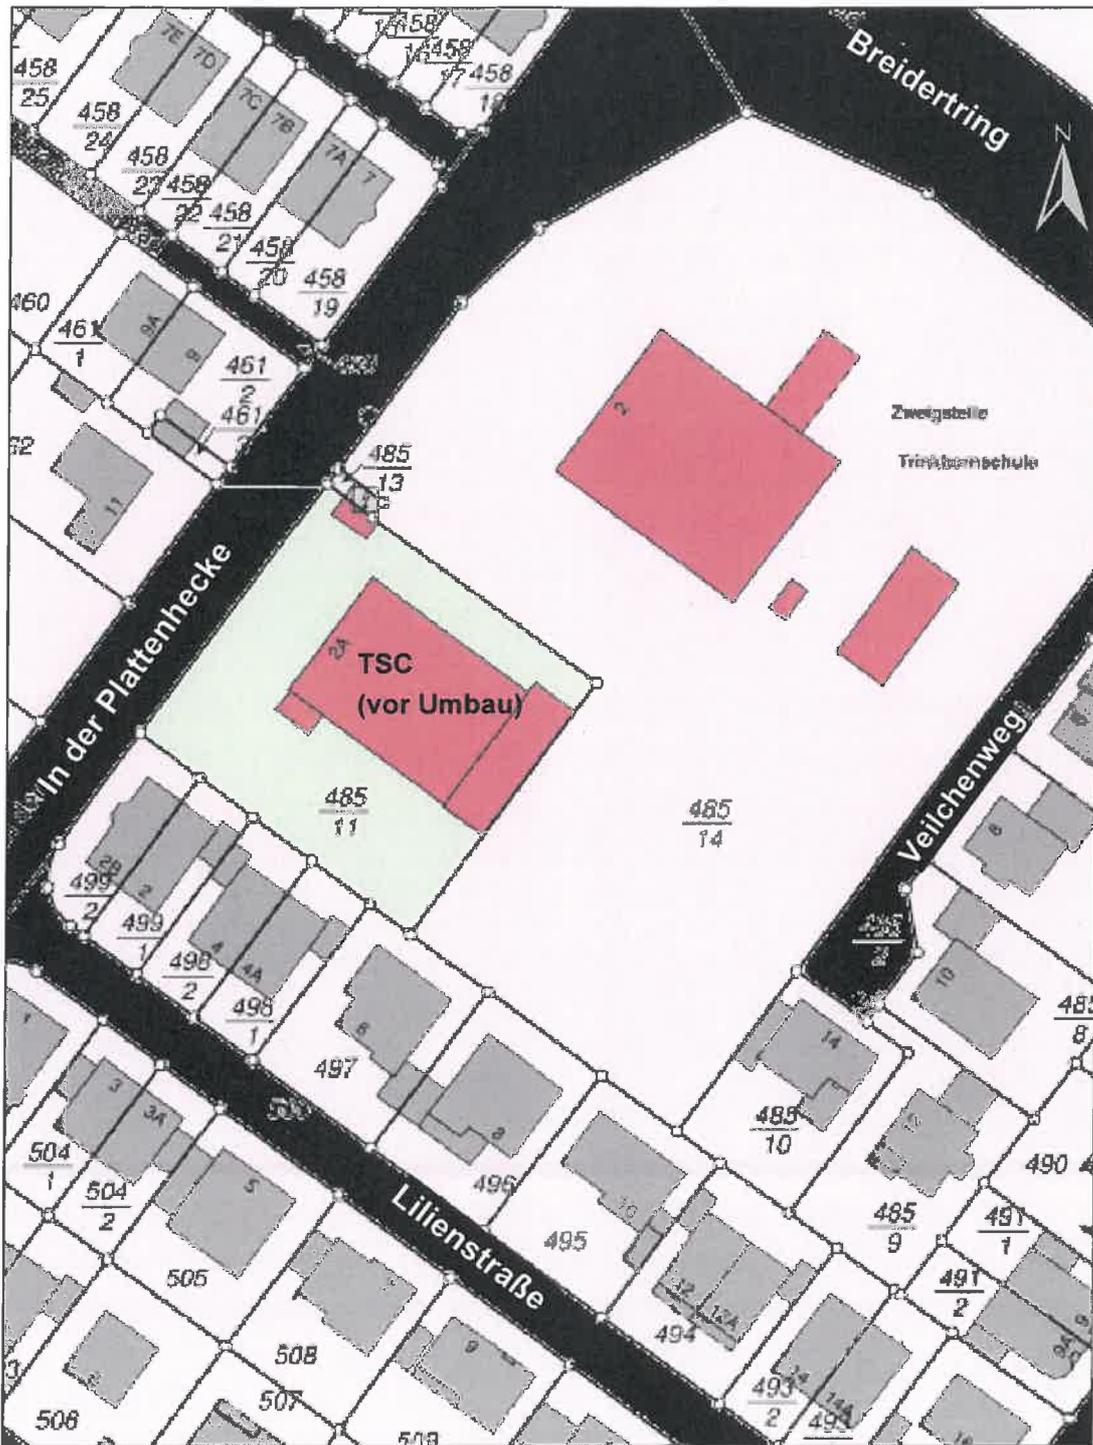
Lageplan der Halle des TSC Rödermark, Maßstab ca. 1 : 1.000
